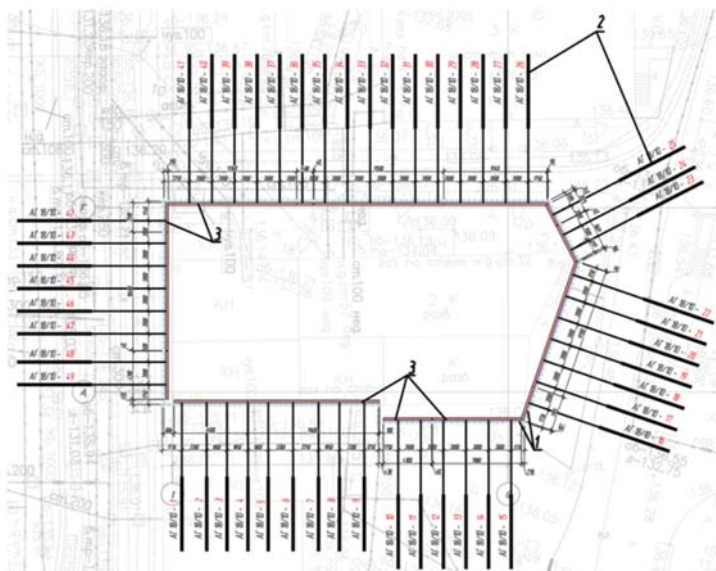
Схема размещения грунтовых анкеров ЭРТ ограждения котлована: 1 – буриинъекционные сваи ЭРТ (РИТ, ФОРСТ, ЭРСТ);
